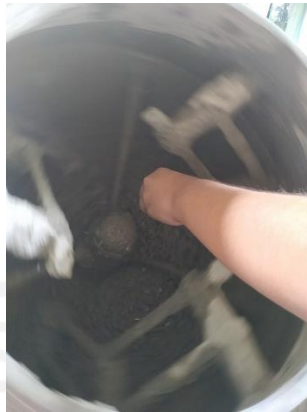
Pencampuran Bahan Penyusun Beton
